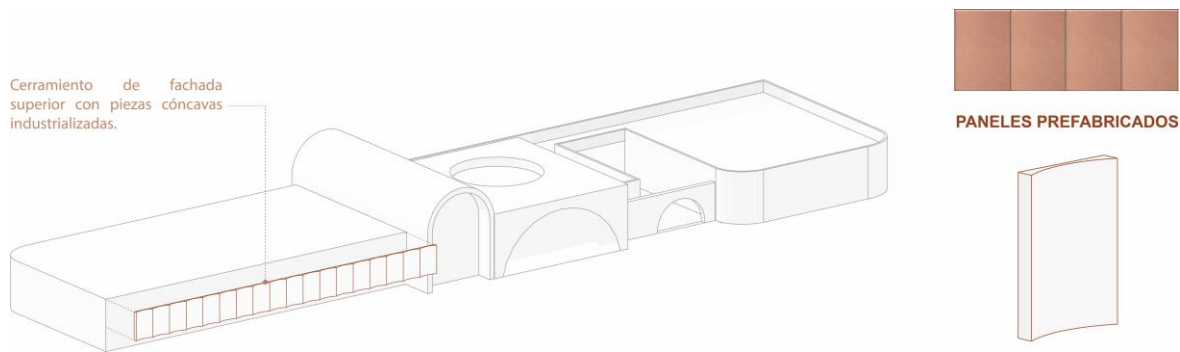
Uso de paneles prefabricados de hormigón en la fachada.
